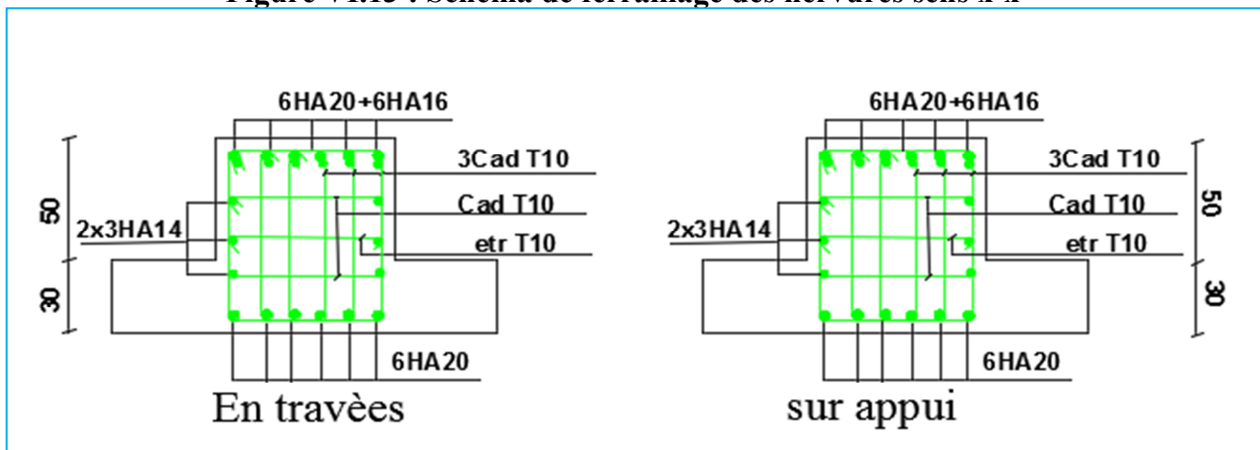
Schéma de ferrailage des nervures sens y-y
